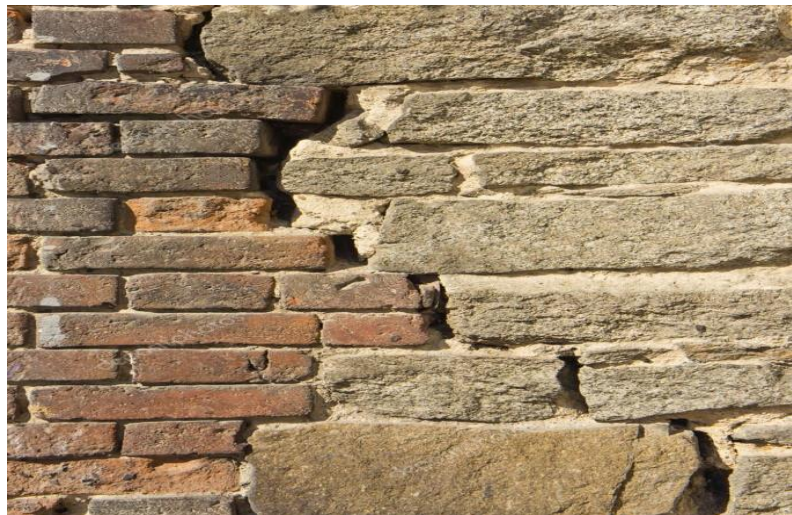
Grieta en muros – fuente Nina maría 12 de mayo 2013.
